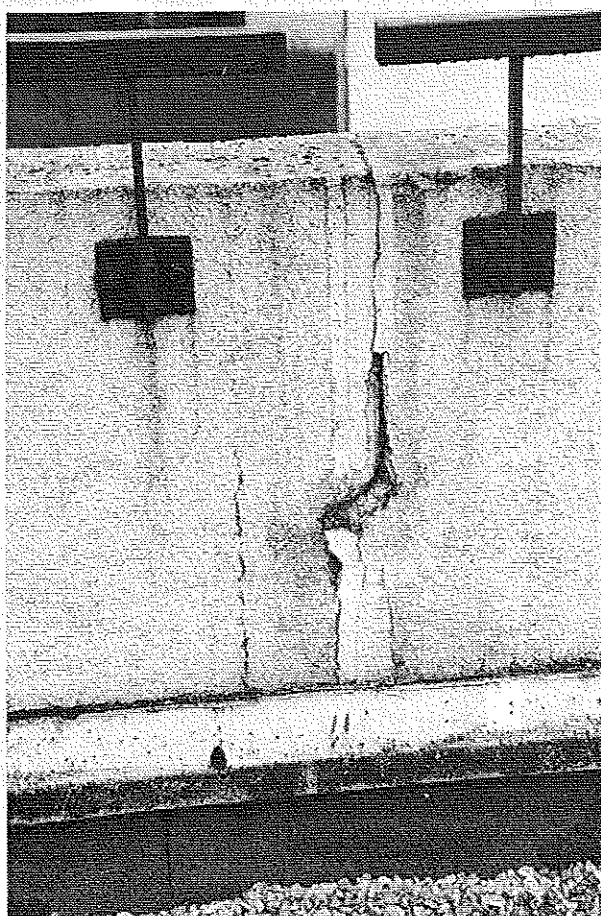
Désordre au droit d'un joint d'acrotère haut. Désorganisation du joint de chaque côté. La fissure se prolonge jusqu'au niveau du couronnement. Elle traverse le joint et le mortier de garnissage a disparu (tracé en Z). Pénétrations d'eau dans le mur d'acrotère derrière le bandeau. © J. Putatti
